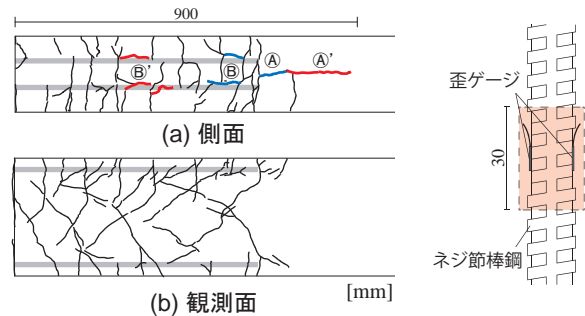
2H上部ひび割れ状況 (R = +1/50)
